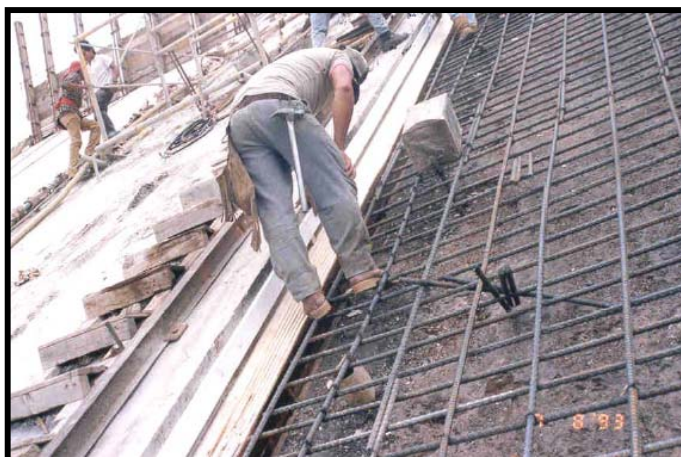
Junta perimetral tipo 1 entre el plinto y la cara de concreto, constituida por madera de encino y roble, y banda de PVC de 0.30 m
